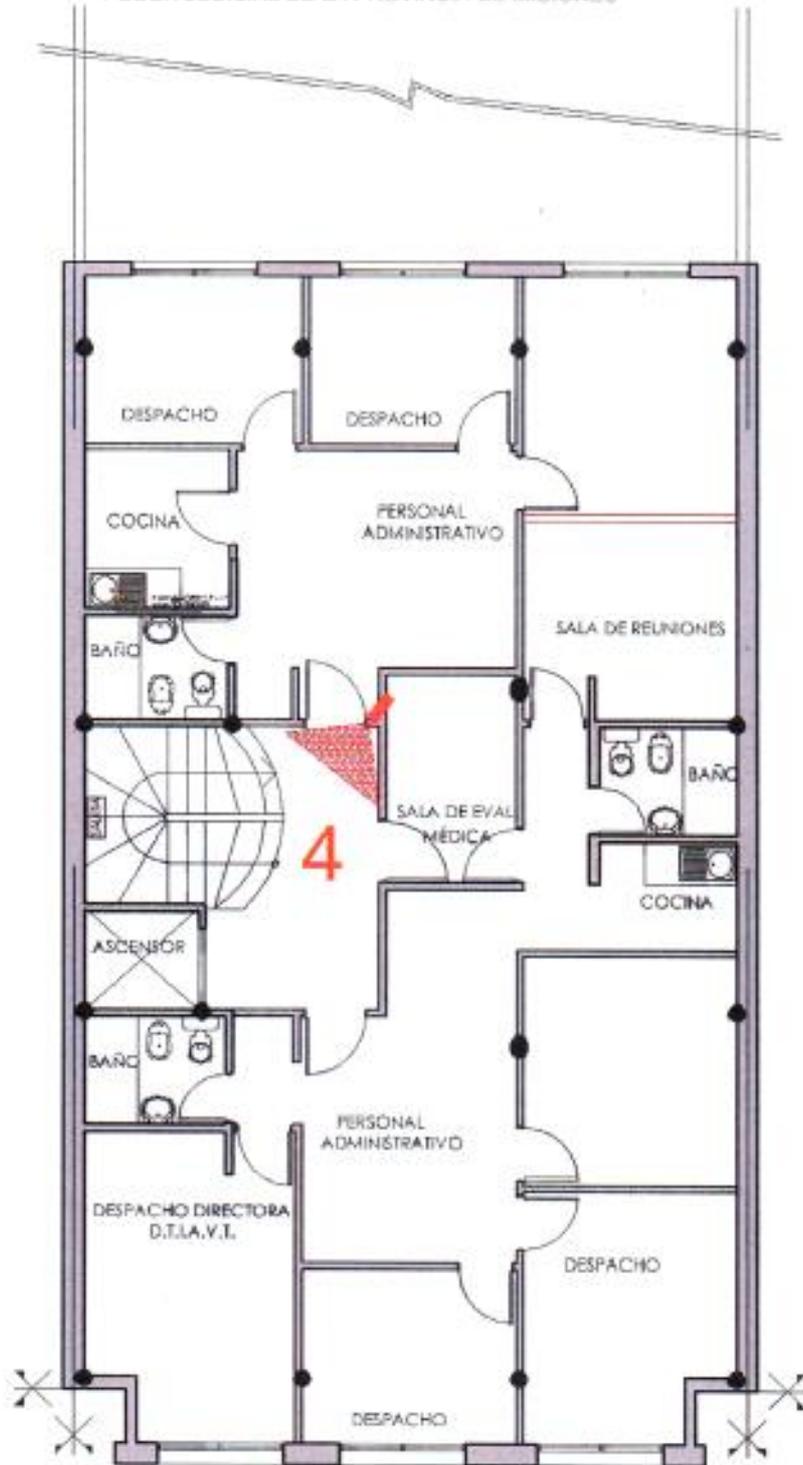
Ilustración orientativa cobertura Cámaras N° 3, 4 y 5 - Por Piso.
